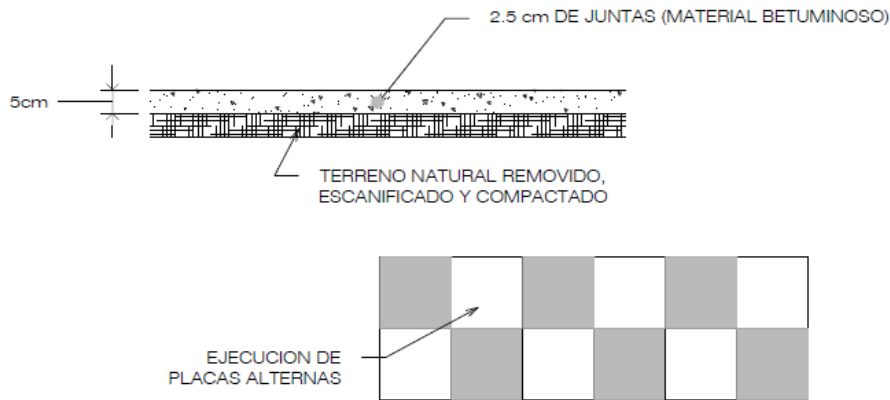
Detalle superficie rodadura en concreto hidráulico.
